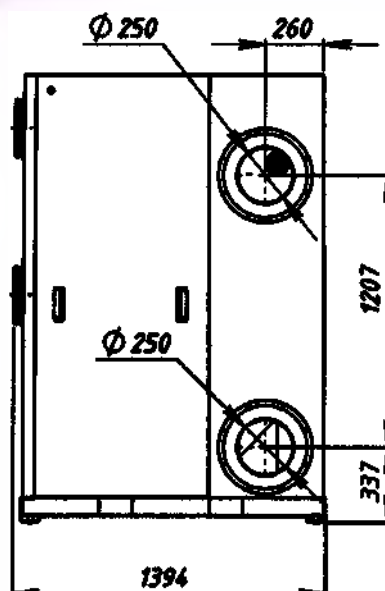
Внешний вид и присоединительные размеры ВХМ
